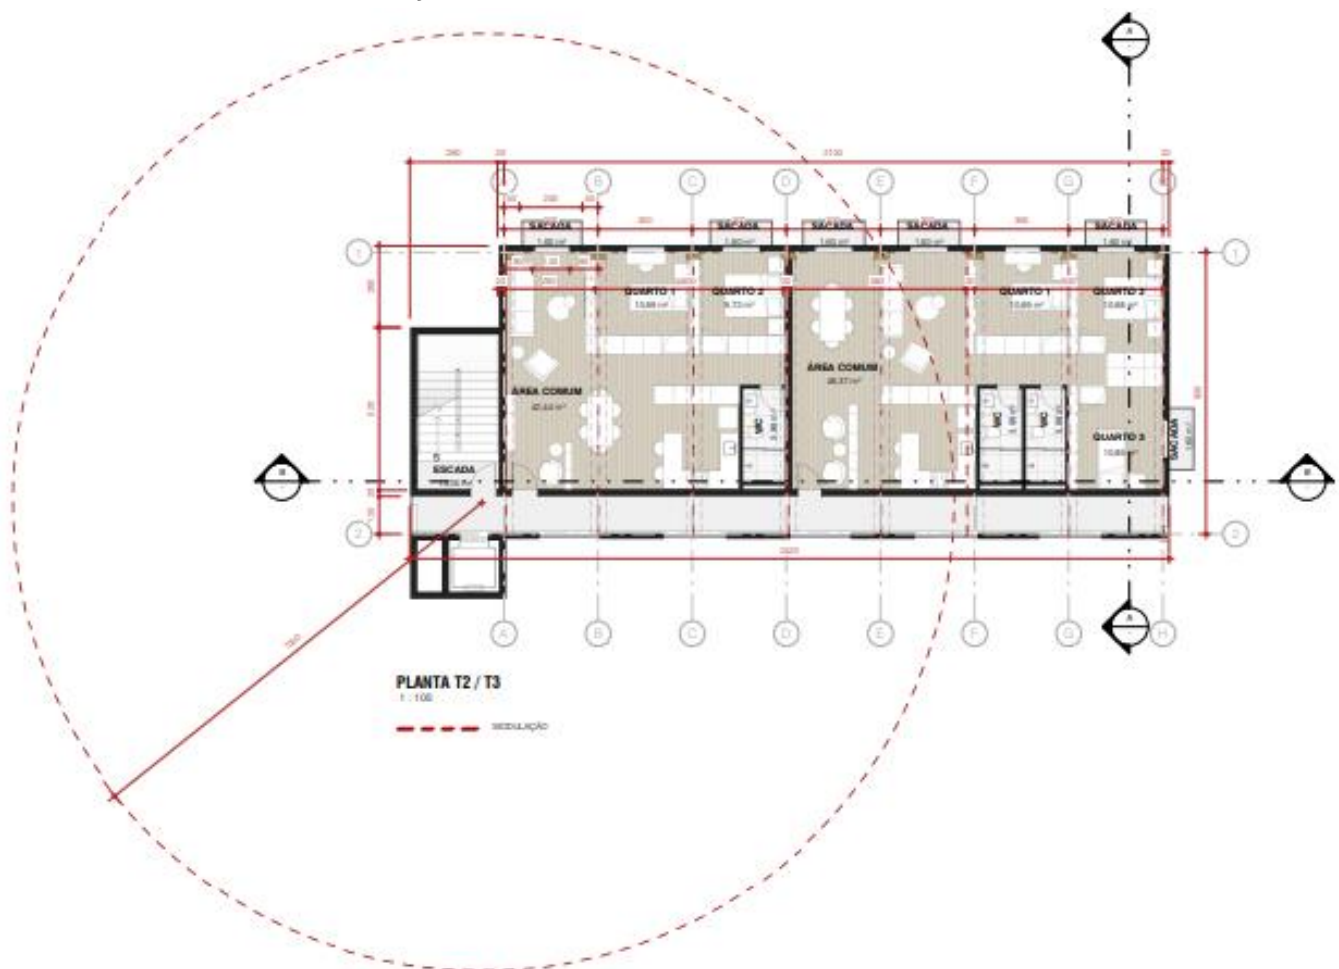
Planta Baixa Base Do Módulo – Fonte: Autoral
